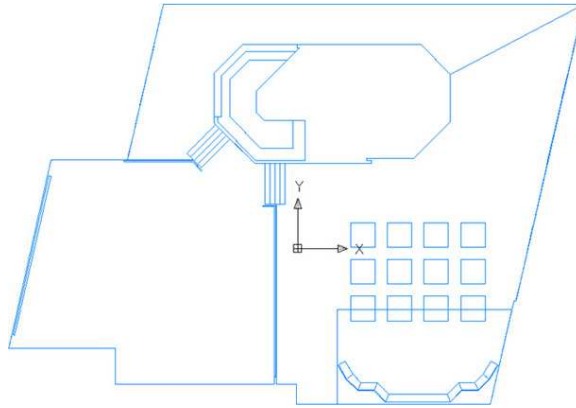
Planta baixa original de uma sala em *AutoCAD*.
